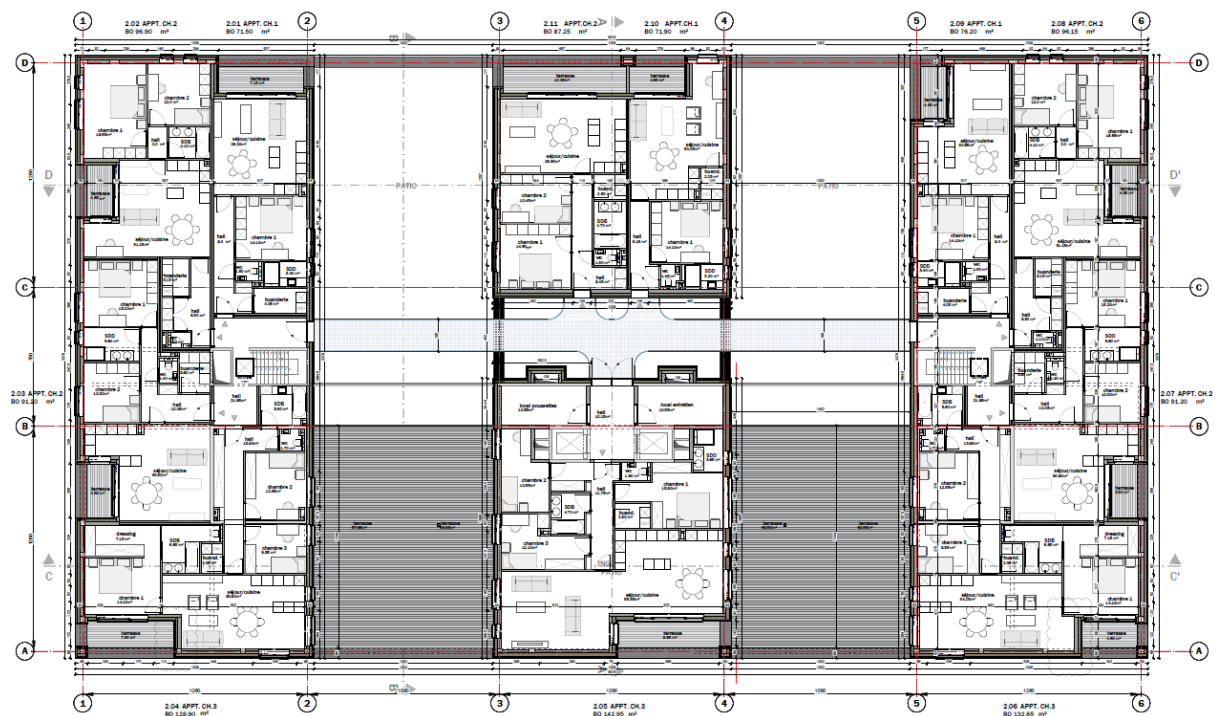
Extrait de plan du R+2 (source : ARTER Architects)
